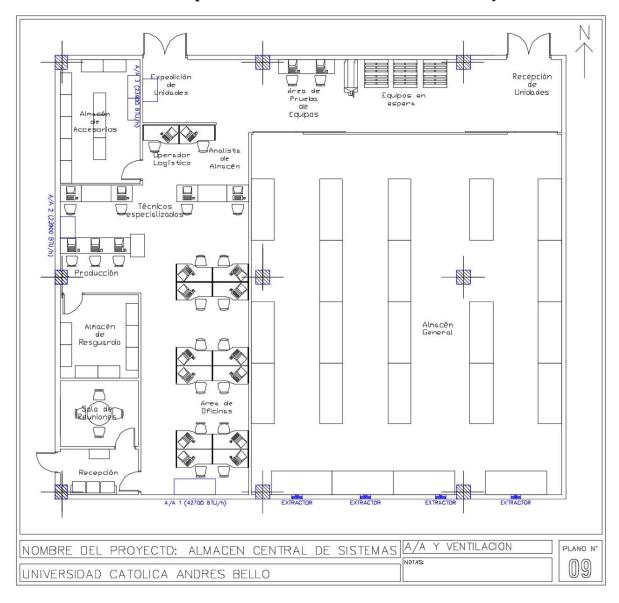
Plano de ubicación de los componentes del sistema de aire acondicionado y ventilación. Fuente: Propia.
